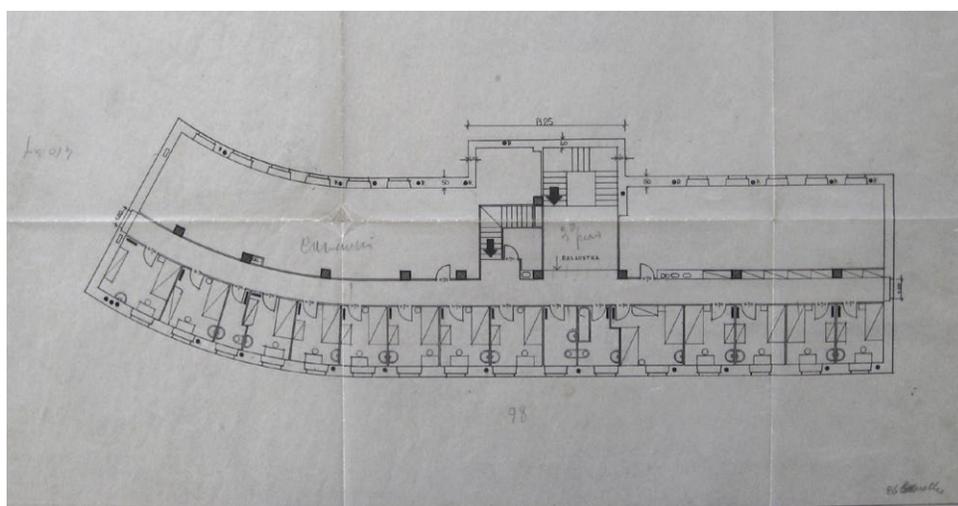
Grundriss 4.OG, 05.07.1935
